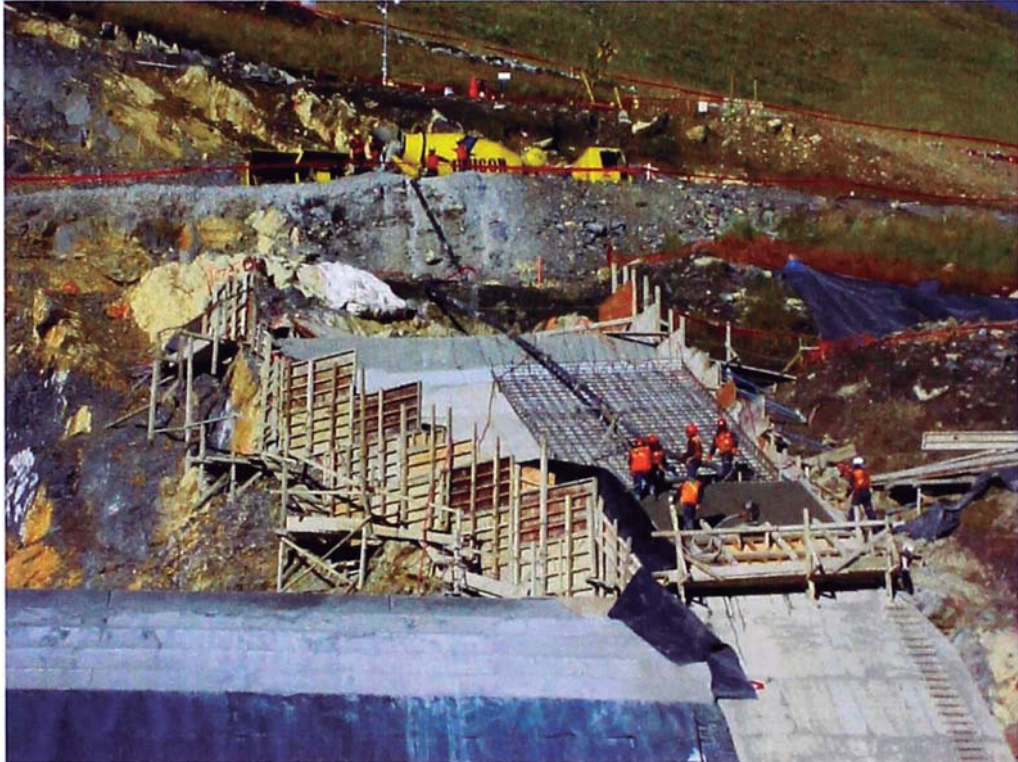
Construcción del Plinto reforzado en el estribo derecho.
